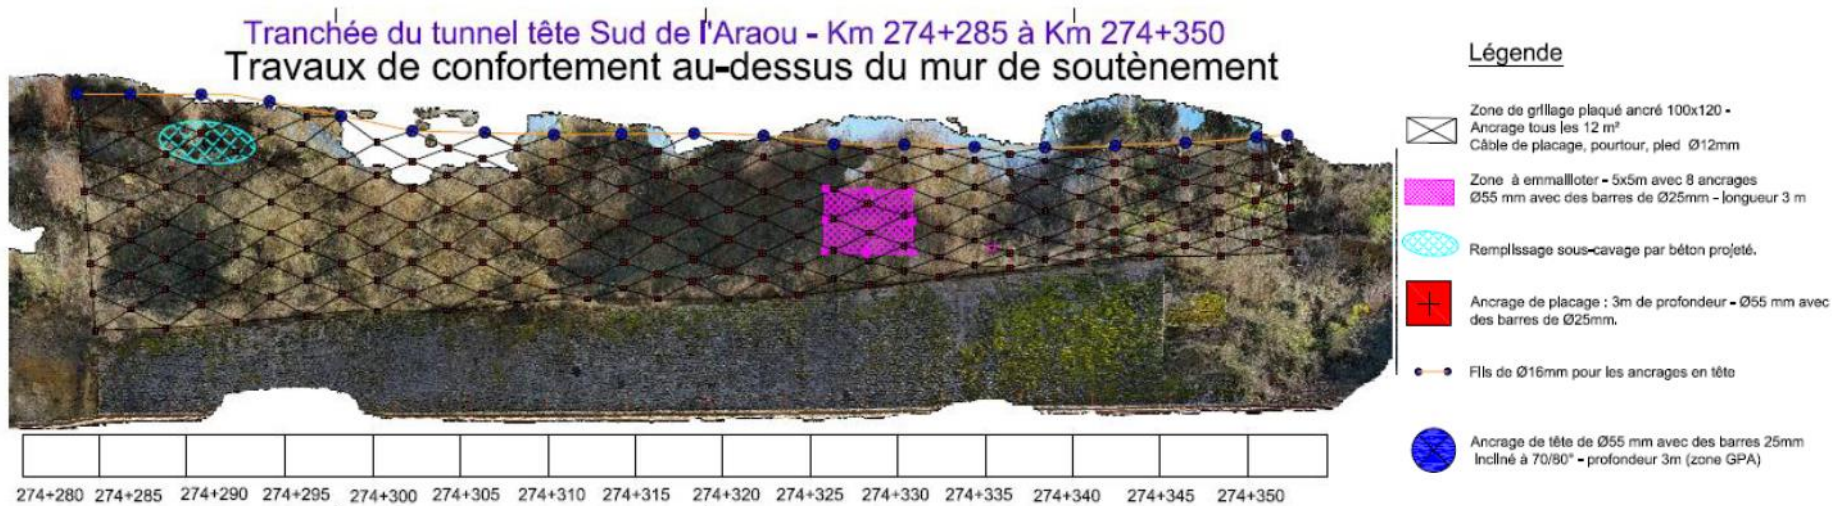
Panorama des travaux de confortement sur la partie au-dessus du mur soutènement du secteur 2
